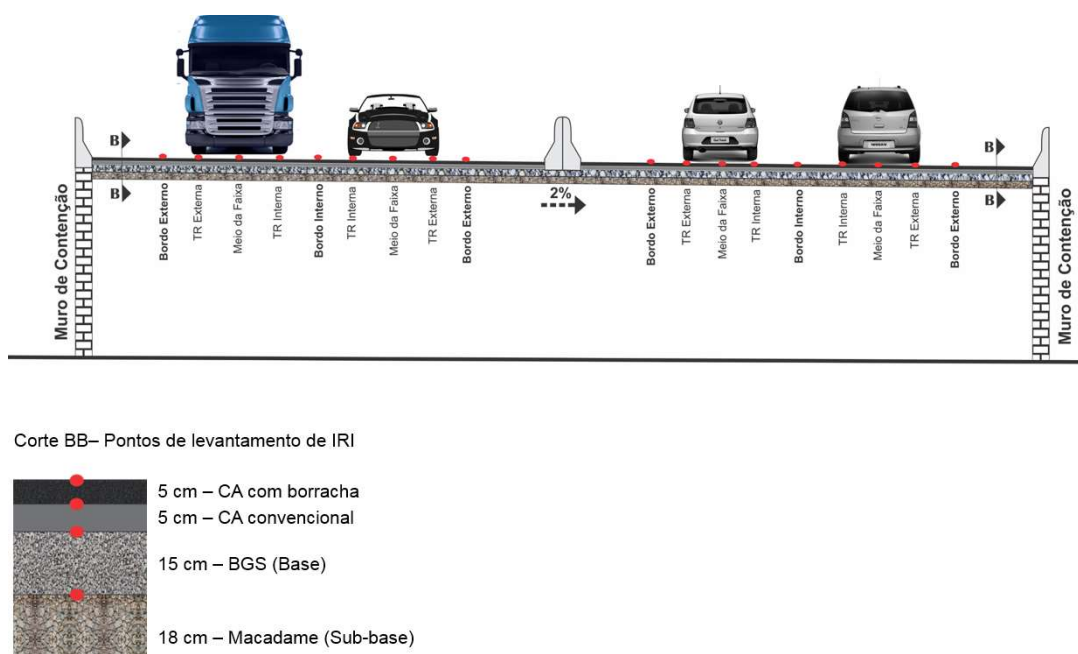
Pontos de levantamento de irregularidade longitudinal–Trecho BR-287/RS
